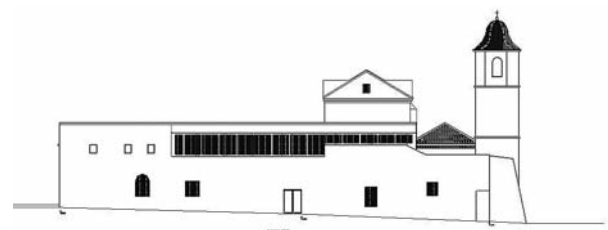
Plano del alzado este del monasterio del Proyecto de Restauración.
